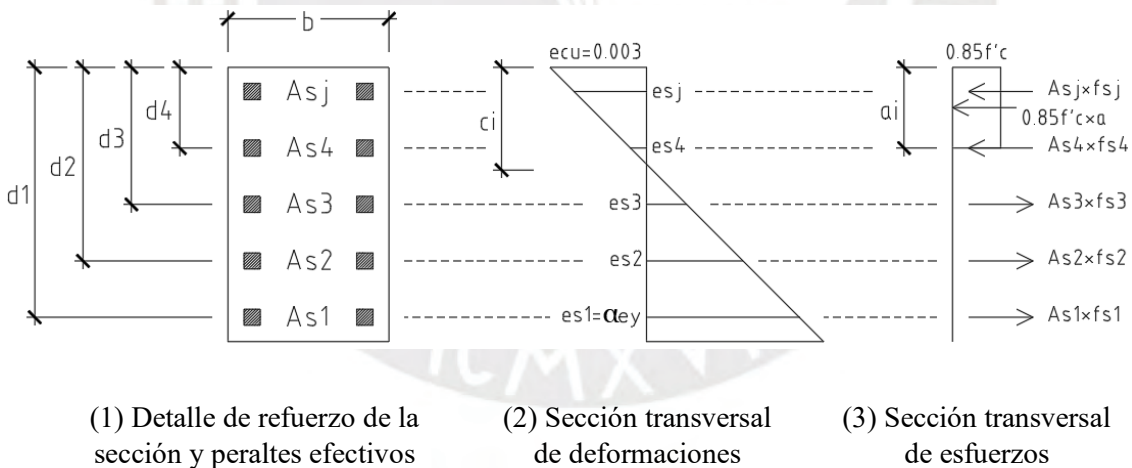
Detalle de sección de concreto armado sometida a flexo-compresión.
